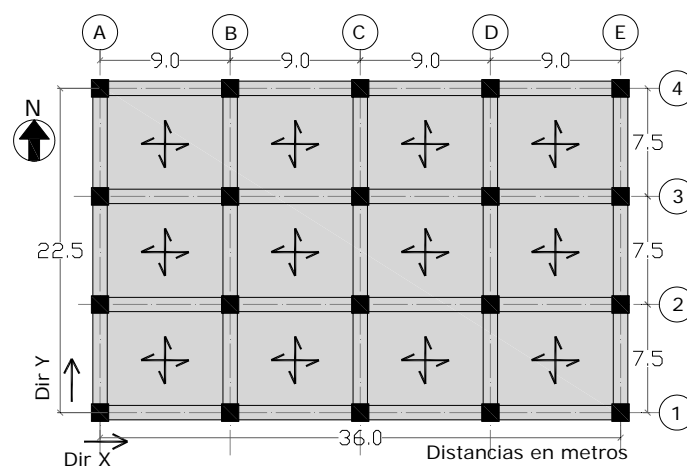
Planta Típica, Adaptada de García (1996)
